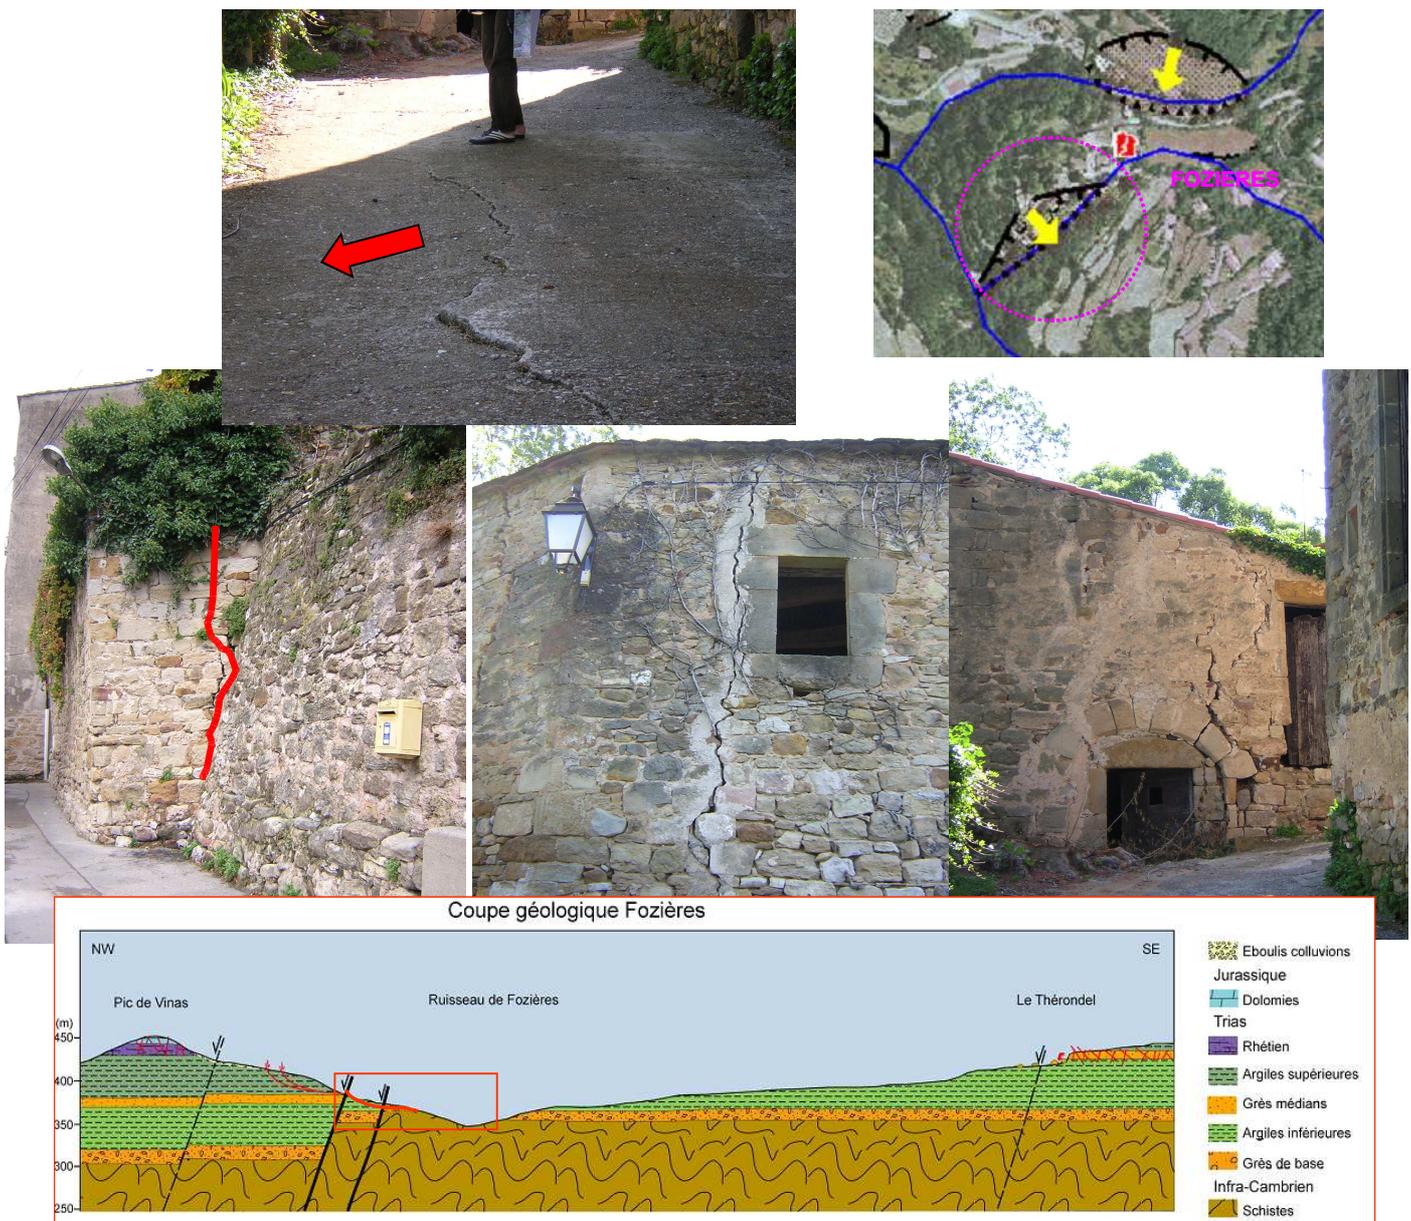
Désordres sur certaines constructions et affaissement de la chaussée liés à un mouvement d'ensemble du versant.
